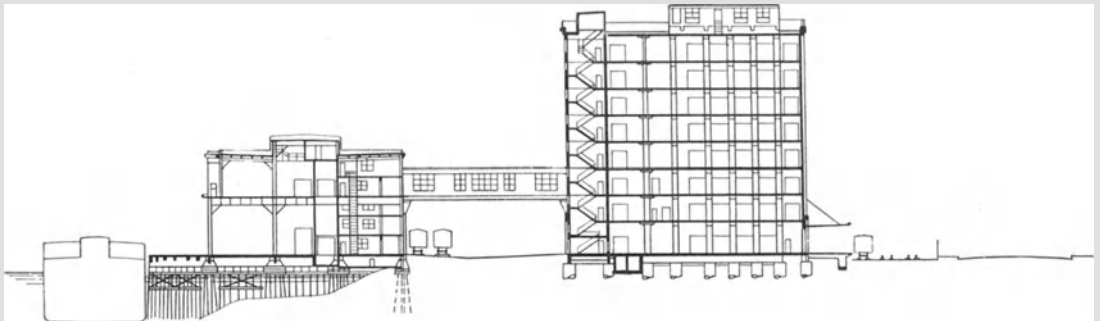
Zweigeschossiger Schuppen mit Speicher in Boston. Maßstab 1 : 1000.
